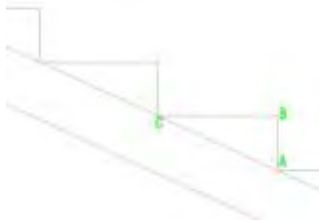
20 Panjang Miring Tangga Tipe 5
